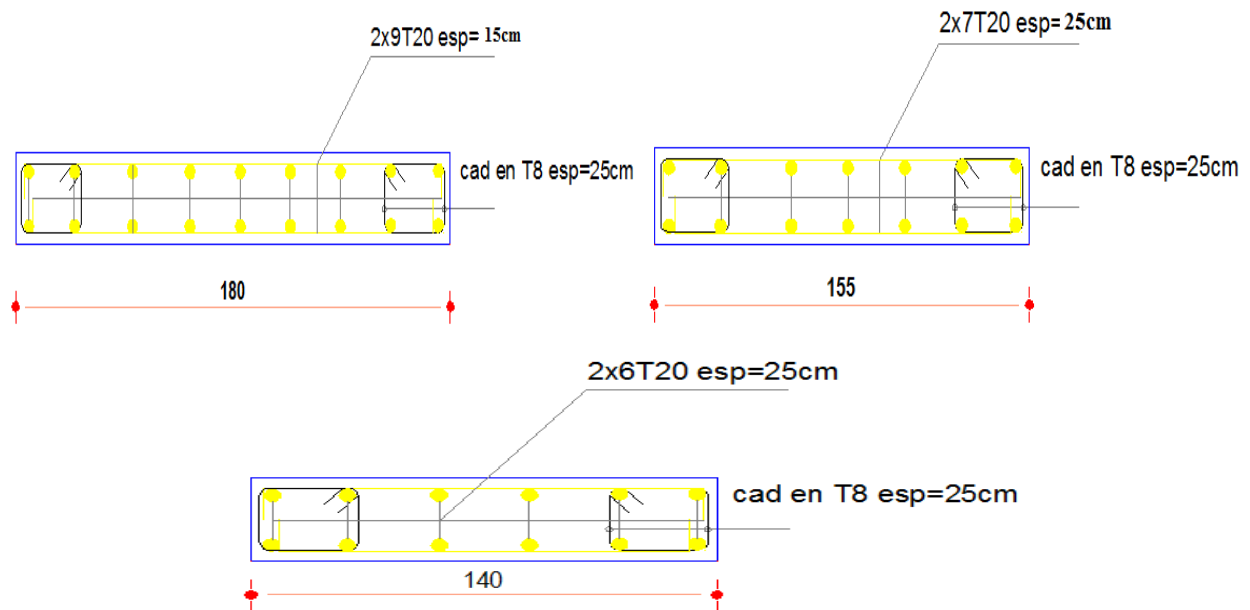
Ferrailage des poteaux sous forme de voile du 3<sup>ème</sup> système
